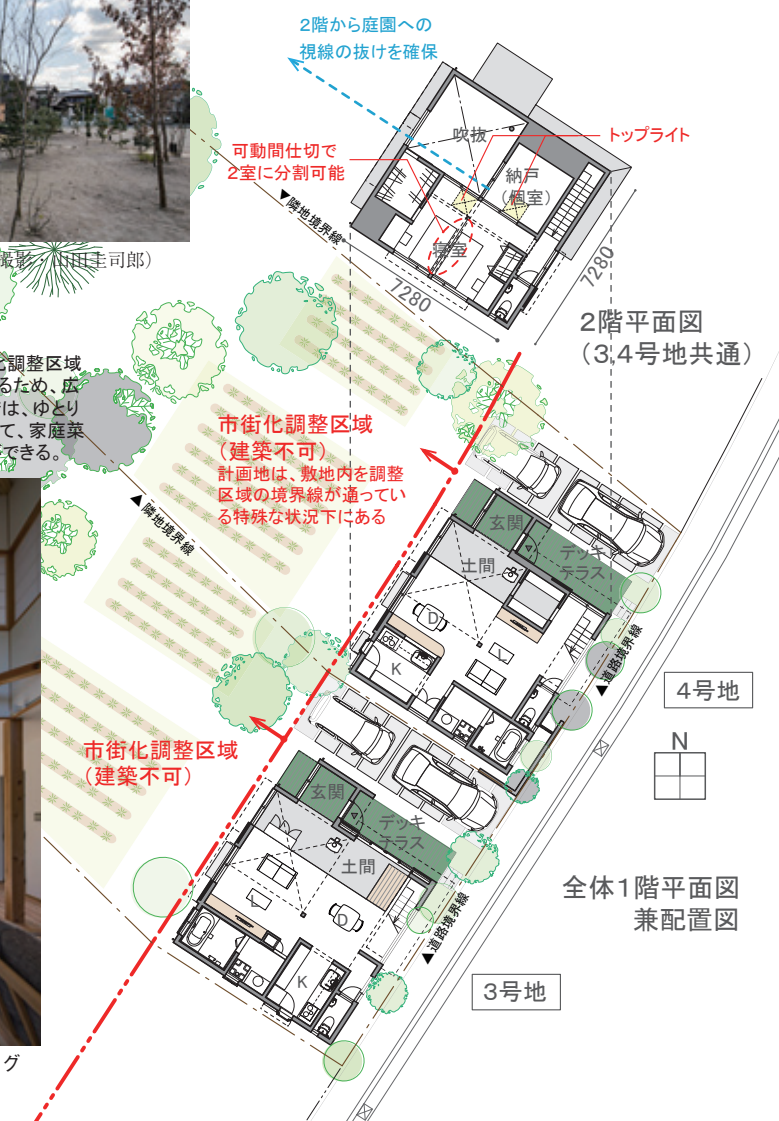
分譲住宅B：平面図兼配置図 1/300
